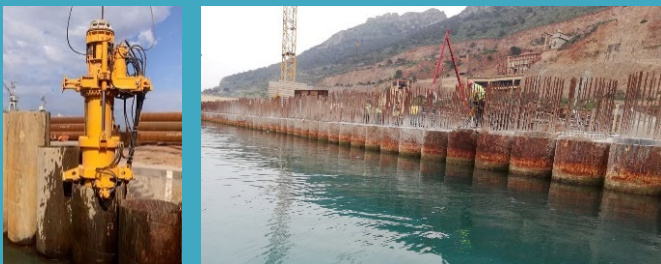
Furação à distância através de fly-drill e execução da cortina de recalce dos muros cais existentes
